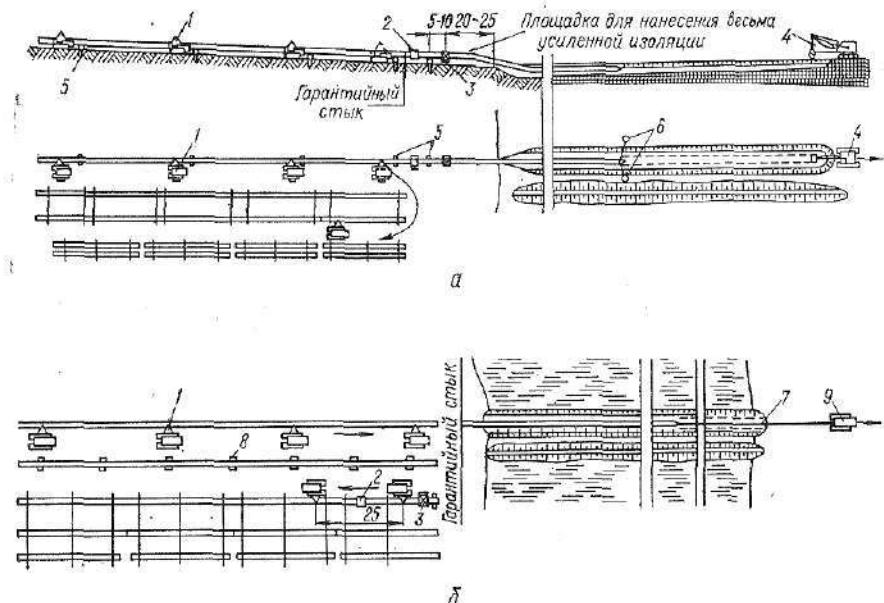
Схемы укладки трубопроводов на болотах сплавом:
